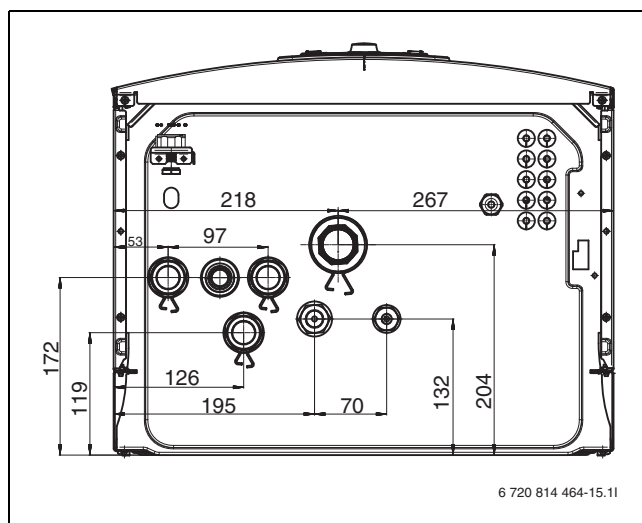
Indeenhed med blandeventil til eksternt tilskud, dimensioner i mm (set nedefra)
